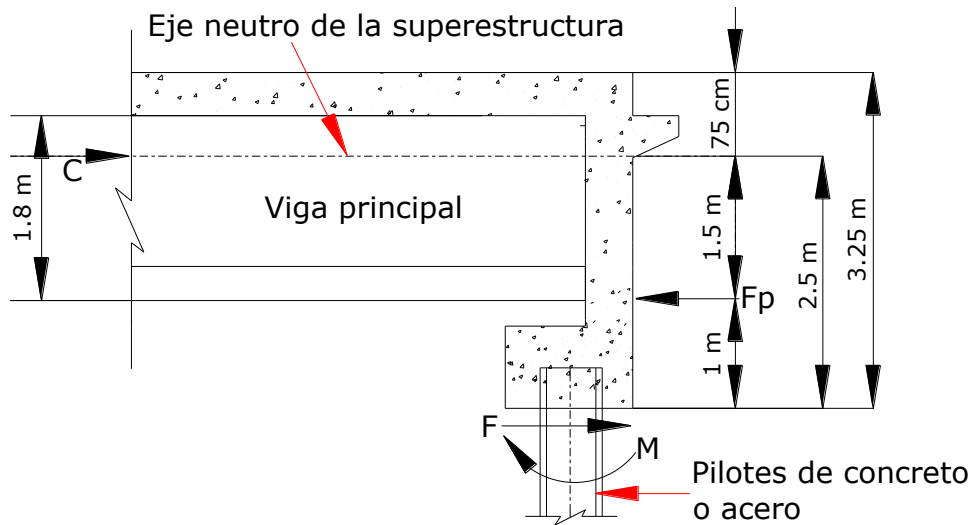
Fuerza de presión pasiva F_p desarrollada por detrás del estribo
